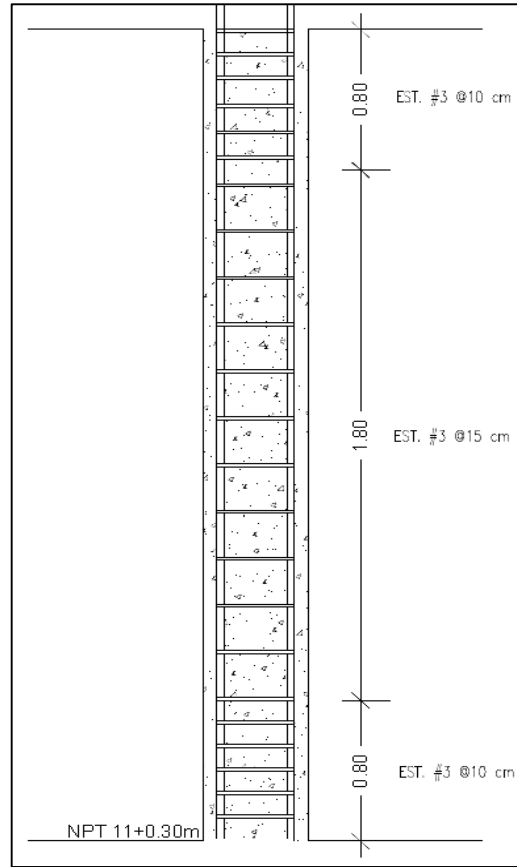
Vista en elevación del armado de la columna propuesta.
